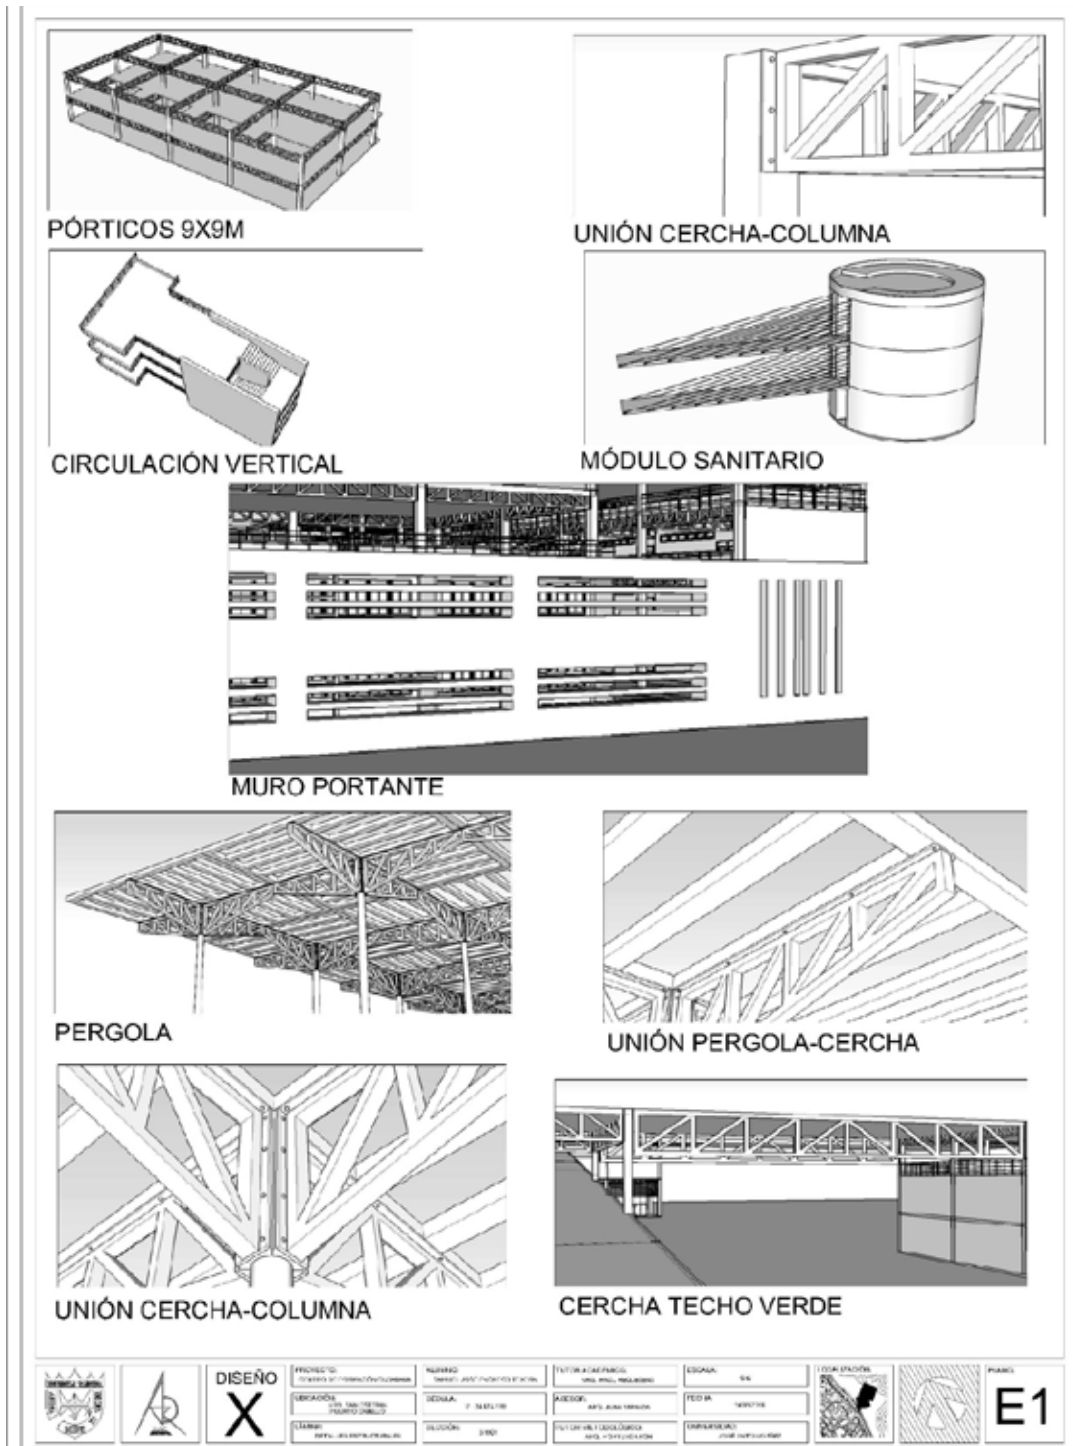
Detalles. Fuente: Propia autoría. (2018).
